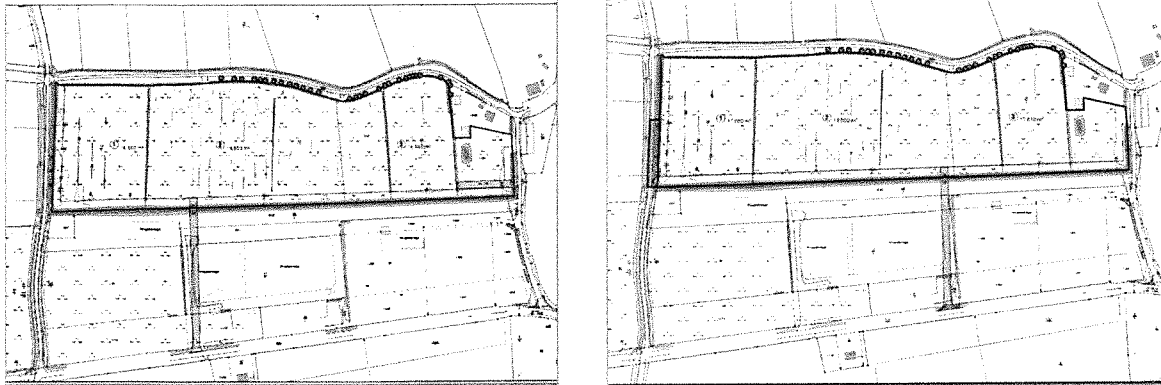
Planungsvarianten 1 und 2 zum Bebauungsplan Nr. 51
